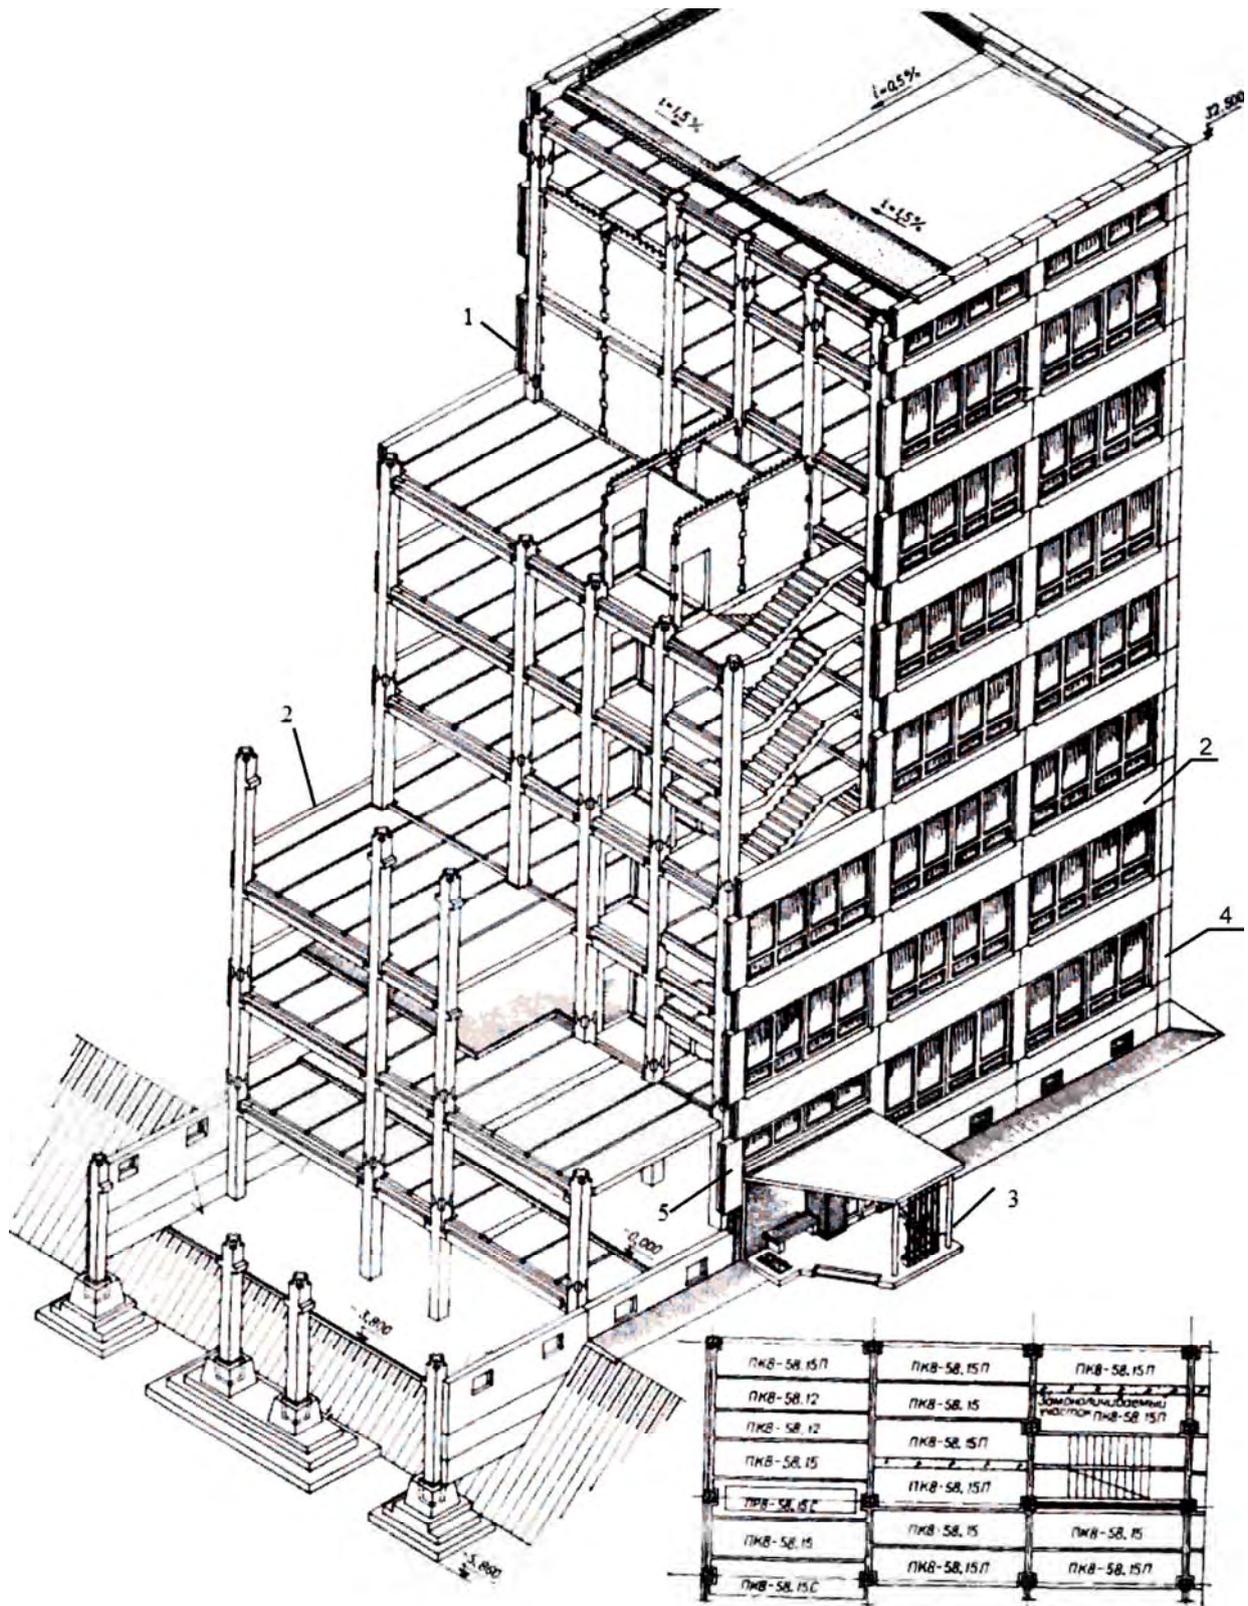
Пространственный разрез здания: 1 — керамзитобетонные простеночные панели; 2 — керамзитобетонная поясная панель; 3 — крыльцо; 4 — керамзитобетонные угловые панели; 5 — простеночная ж/б панель
